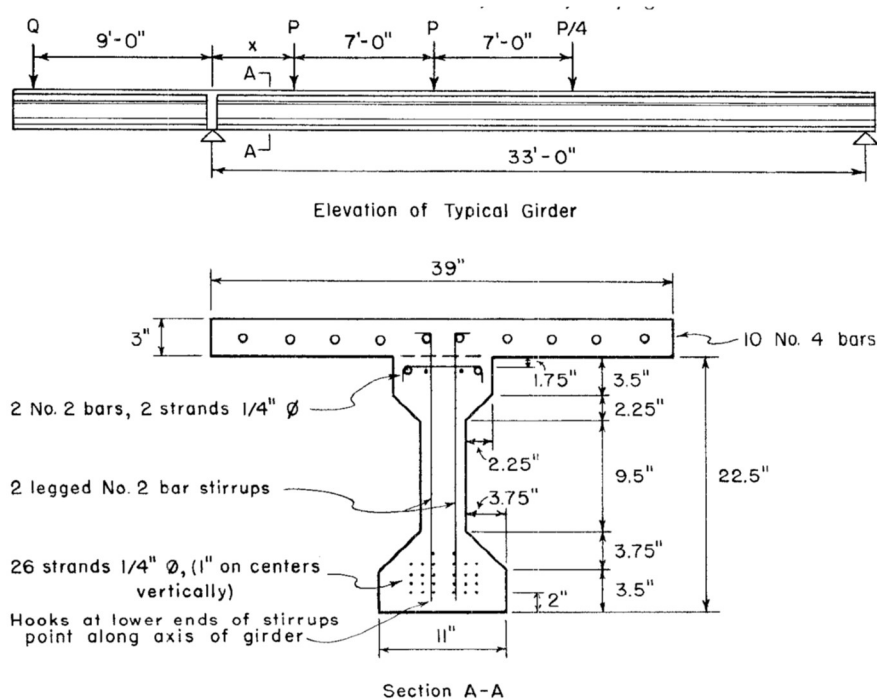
Geometria das vigas ensaiadas por Mattock & Kaar (1961).
